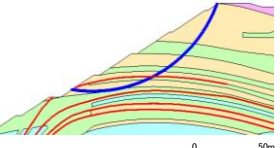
解析モデル図 (⑤-⑤' 断面)
